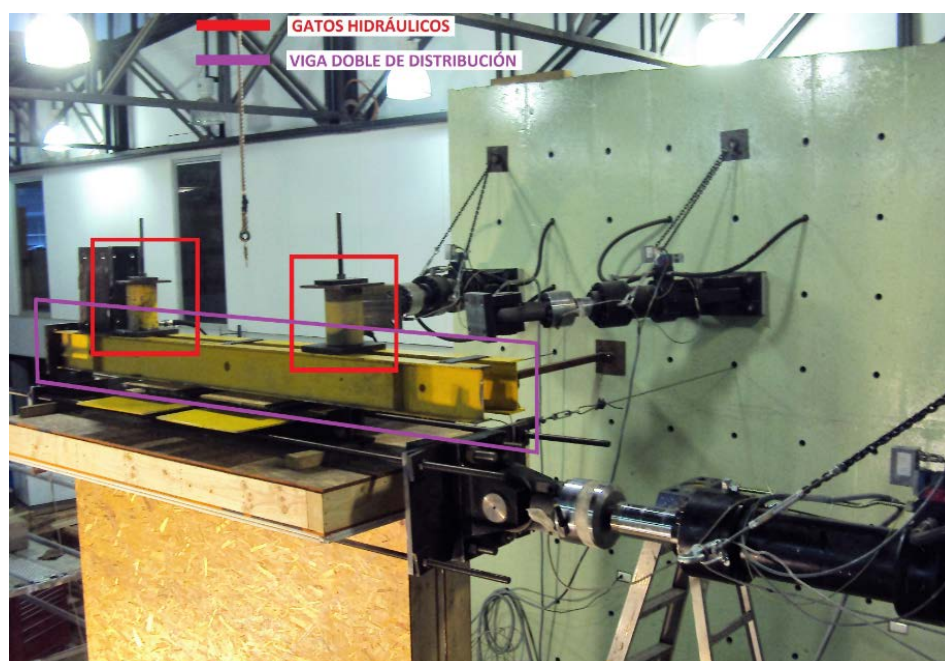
Vista Superior del Muro No. 2 con ubicación de gatos de aplicación de carga axial y viga doble de distribución.
